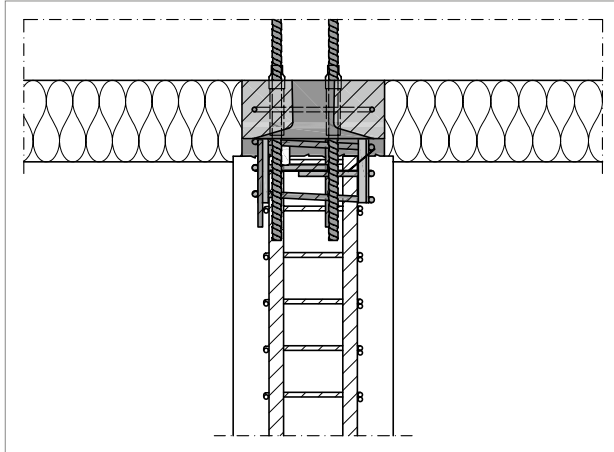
Schöck Sconnex® Typ P-O: Bewehrungsführung im Bereich 1 – Stützenlängsschnitt (gilt auch für Typ P-U)
